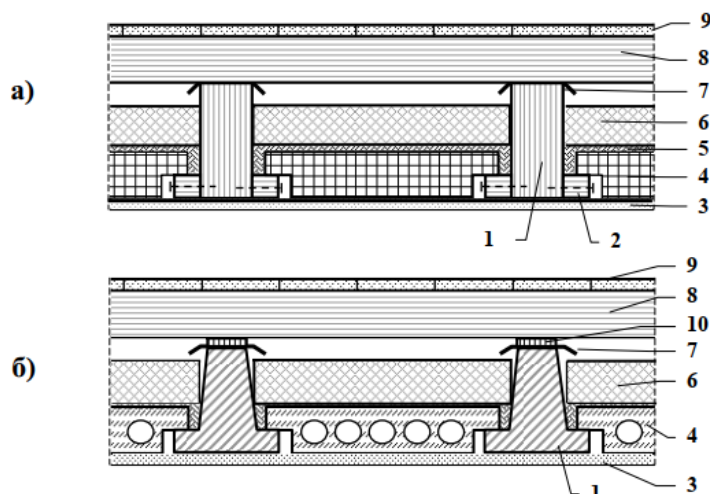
Приклади влаштування балочних перекриттів: а – схема перекриття по дерев'яних балках; б – схема перекриття по залізобетонних балках; 1 – балка; 2 – черепний брус (прибоїна); 3 – штукатурка по підшивці; 4 – накат; 5 – обмазка; 6 – звуко-теплоізоляція; 7 – гідроізоляція; 8 – лага; 9 – чорна дощата підлога; 10 – антисептована дерев'яна прокладка
